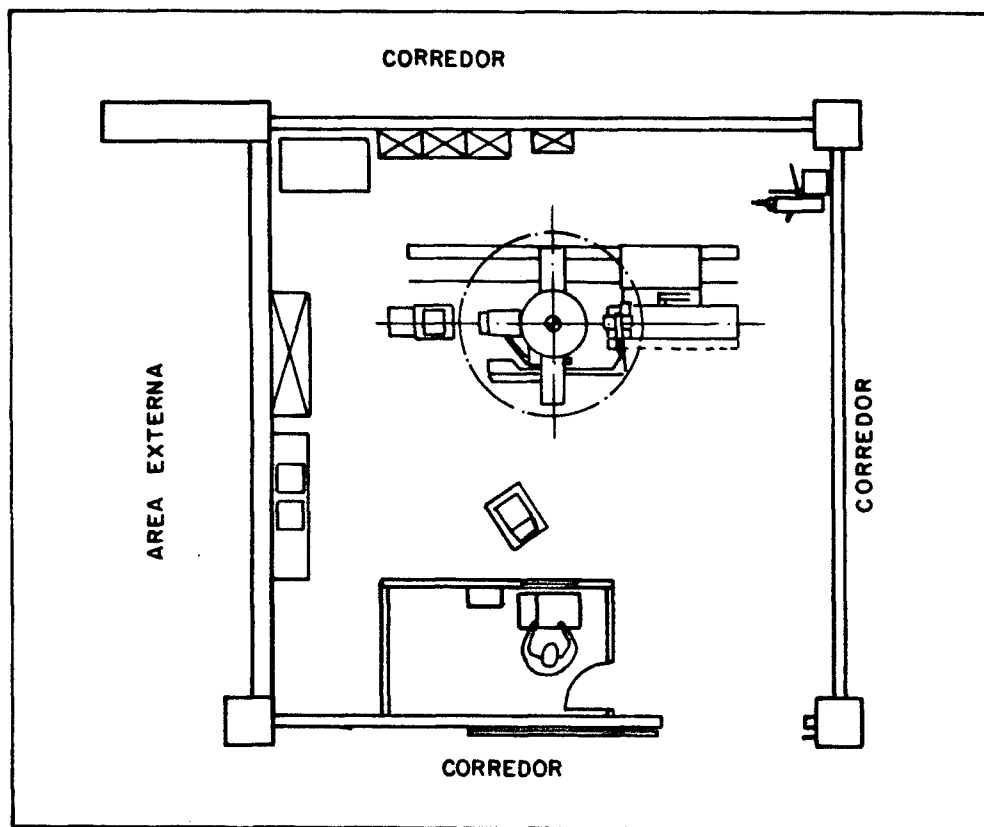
PLANTA DA SALA ONDE SE ENCONTRA O APARELHO DE RAIOS X MIMER III - SIEMENS
